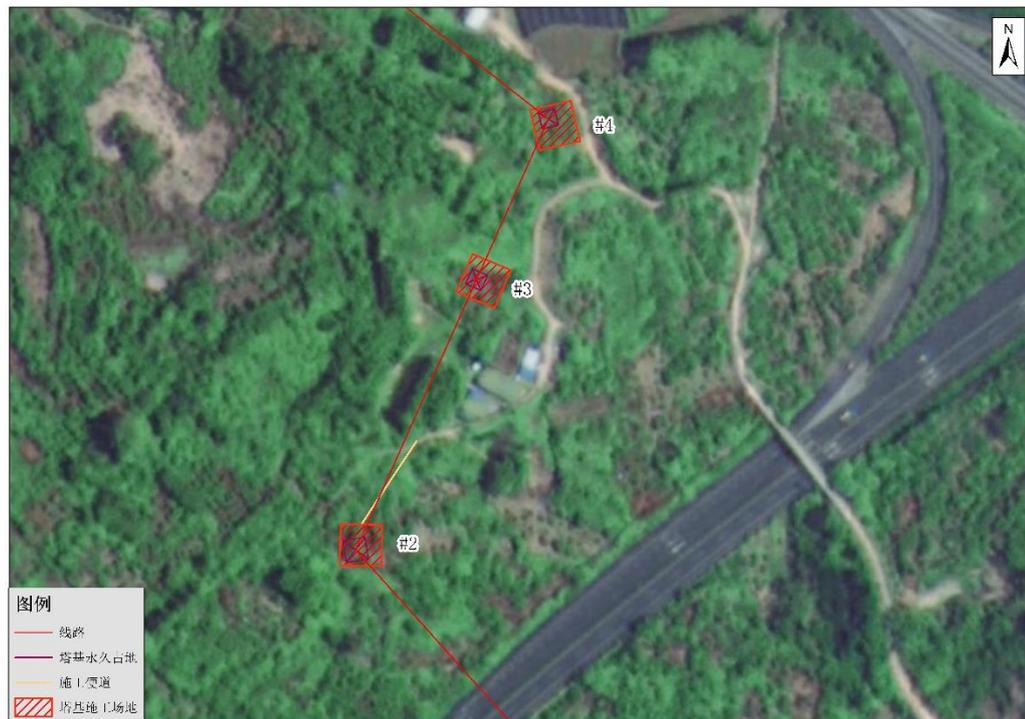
项目施工场地布置情况示意（根据实际施工要求为准）
